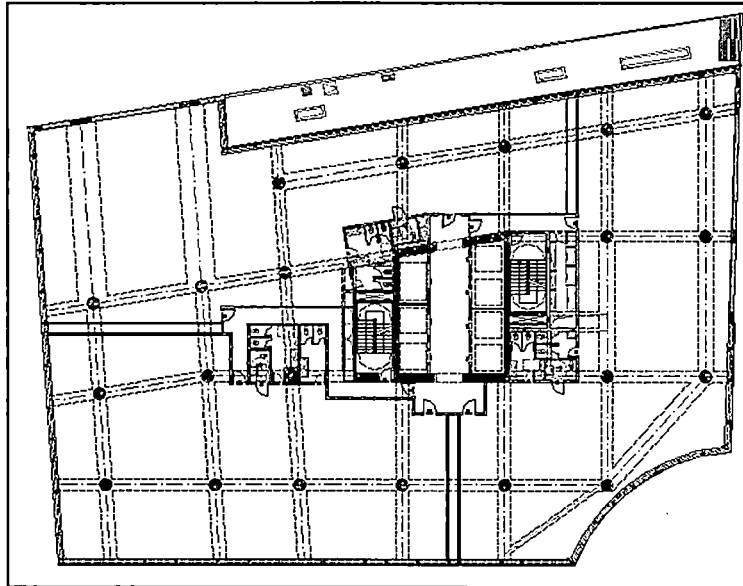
Plano de estructuras, piso 4 típico. Real 8.
